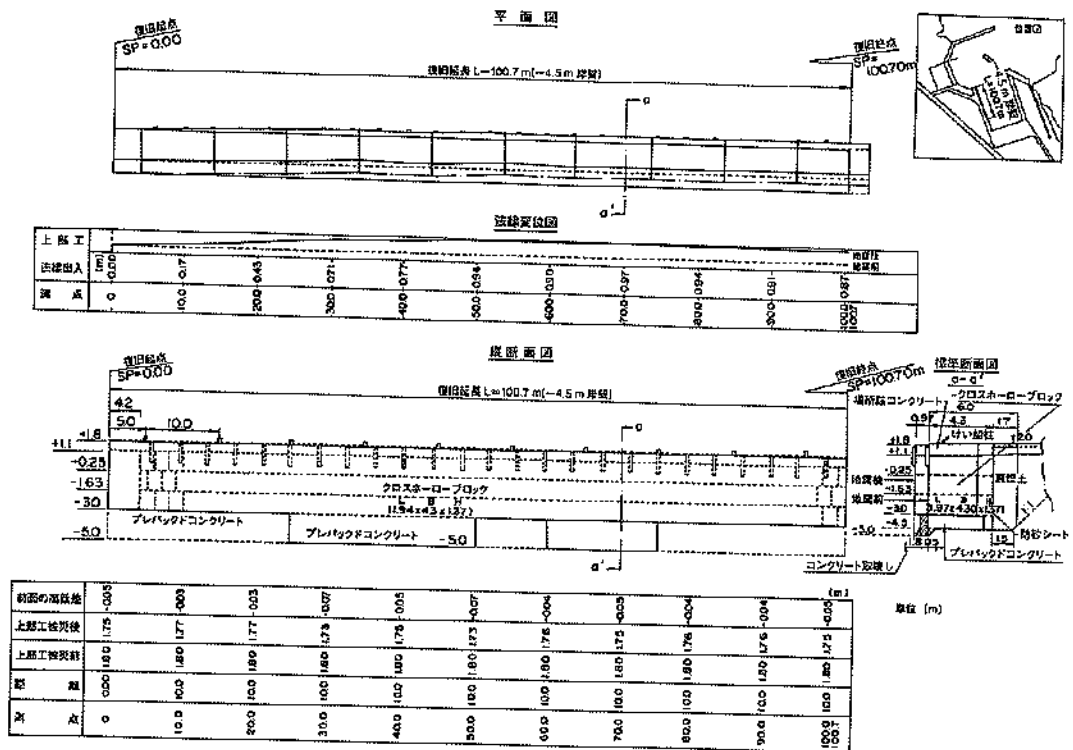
被災状況平面図・縦断面図・標準断面図 (須築漁港、②-4.5m岸壁)
